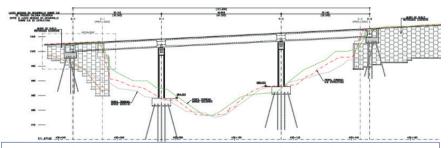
Alzado esquemático del viaducto 'pequeño' de la calzada sentido Madrid.
